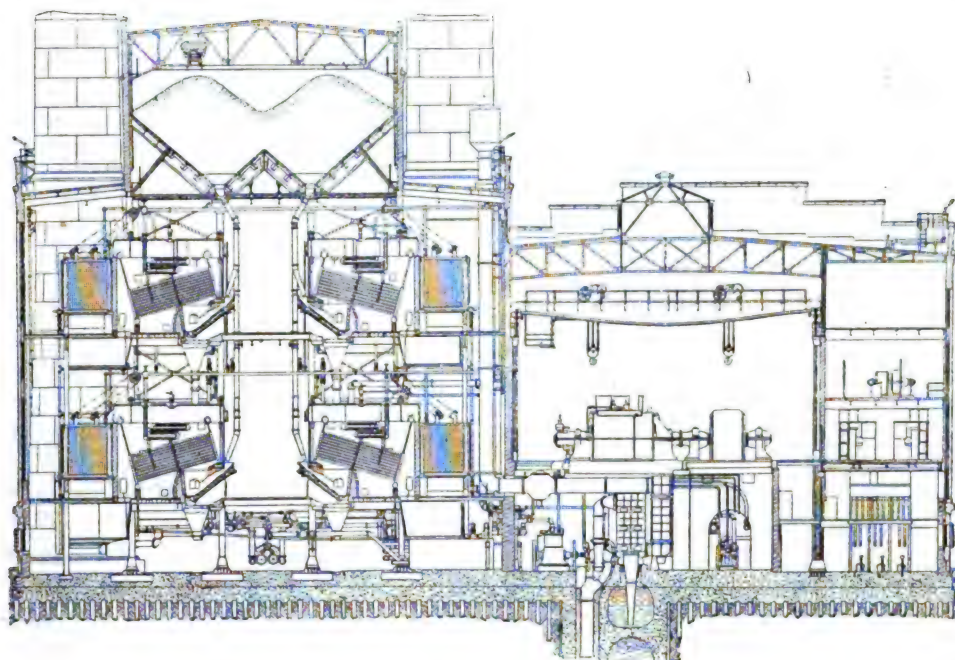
Vue en coupe de la disposition générale de l'usine.
